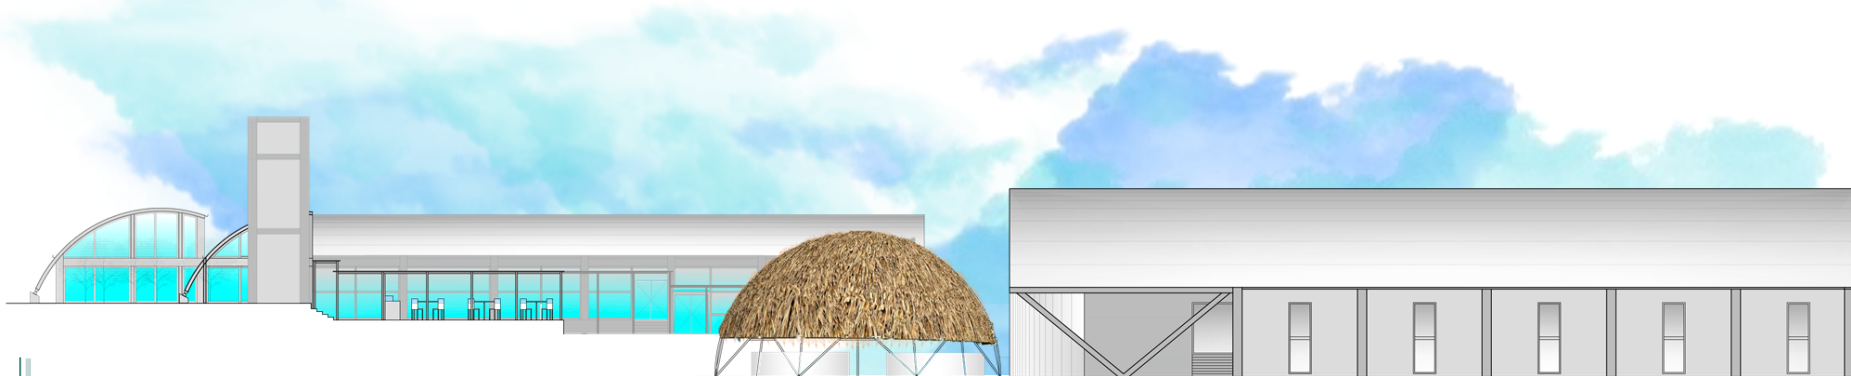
Fachada oriente de conjunto. Elaboración propia.
